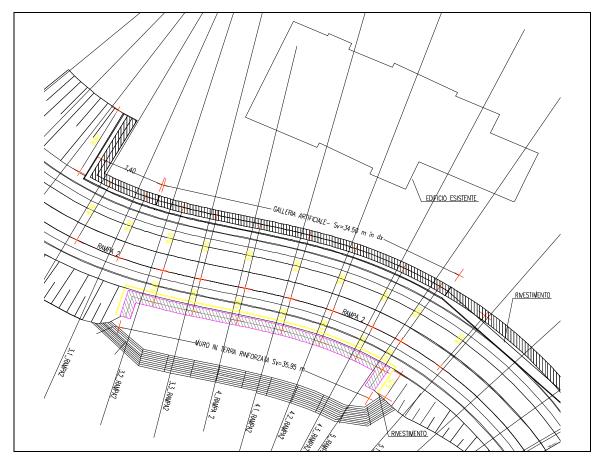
Stralcio planimetrico galleria artificiale RAMPA 2
